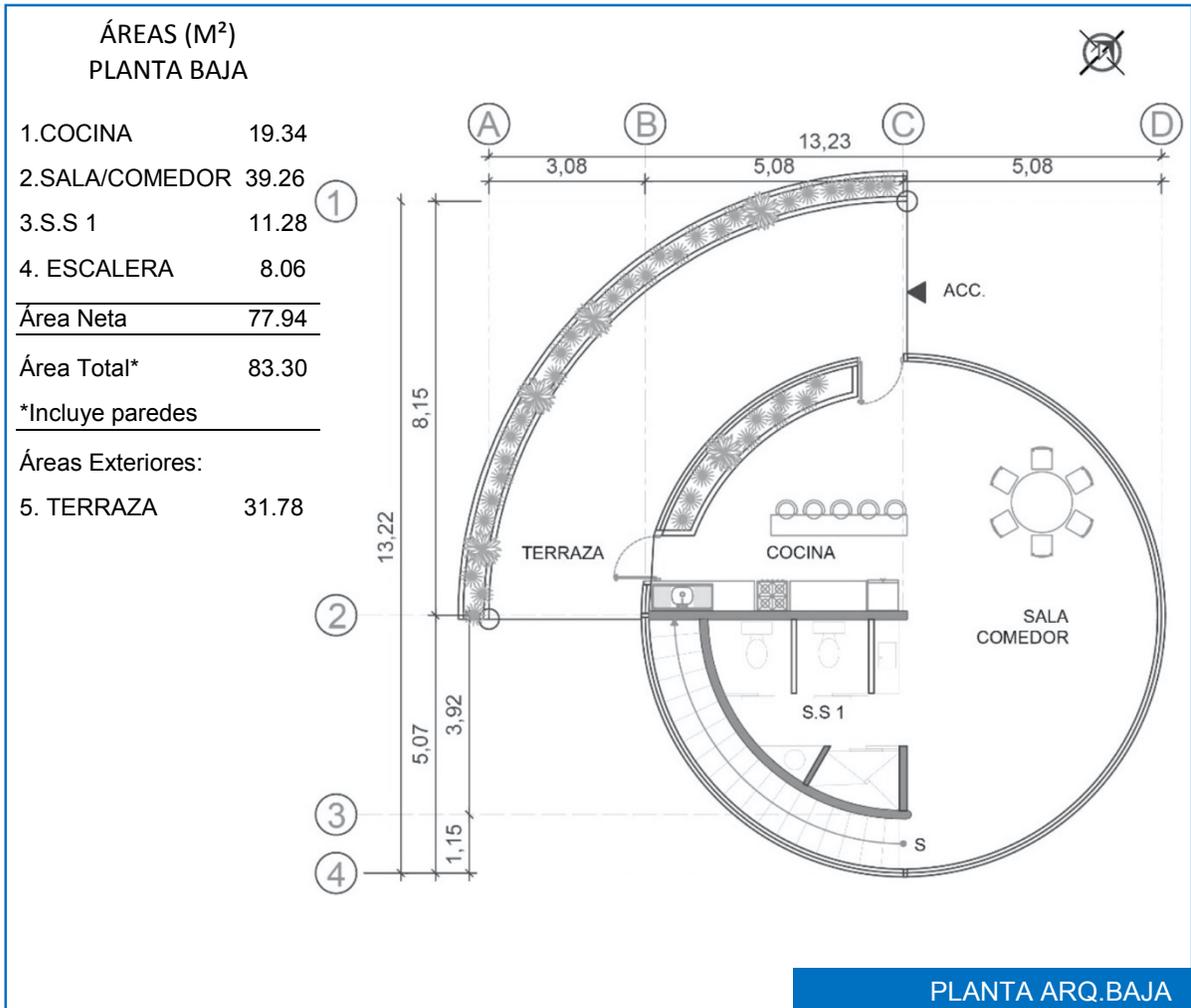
Planta Arquitectónica Baja. Fuente: Autor. Programa: Autocad
